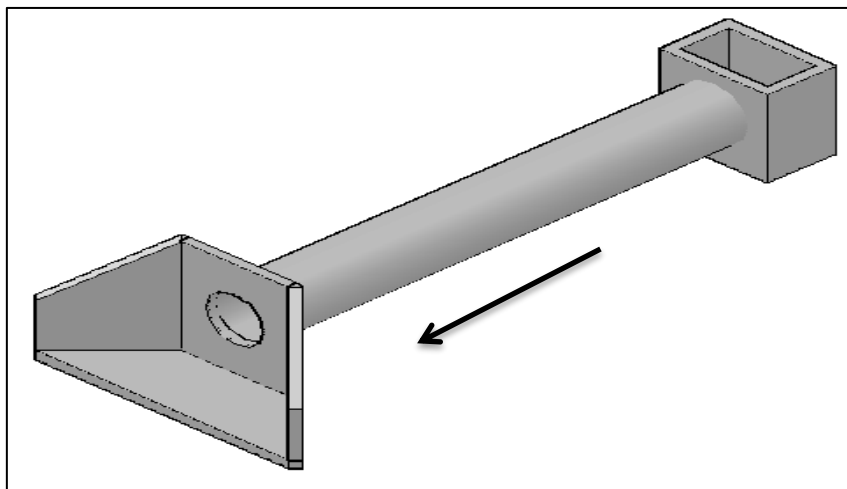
Alcantarilla con estructura de cajón a la entrada y cabezal con muro de alas a la salida.
